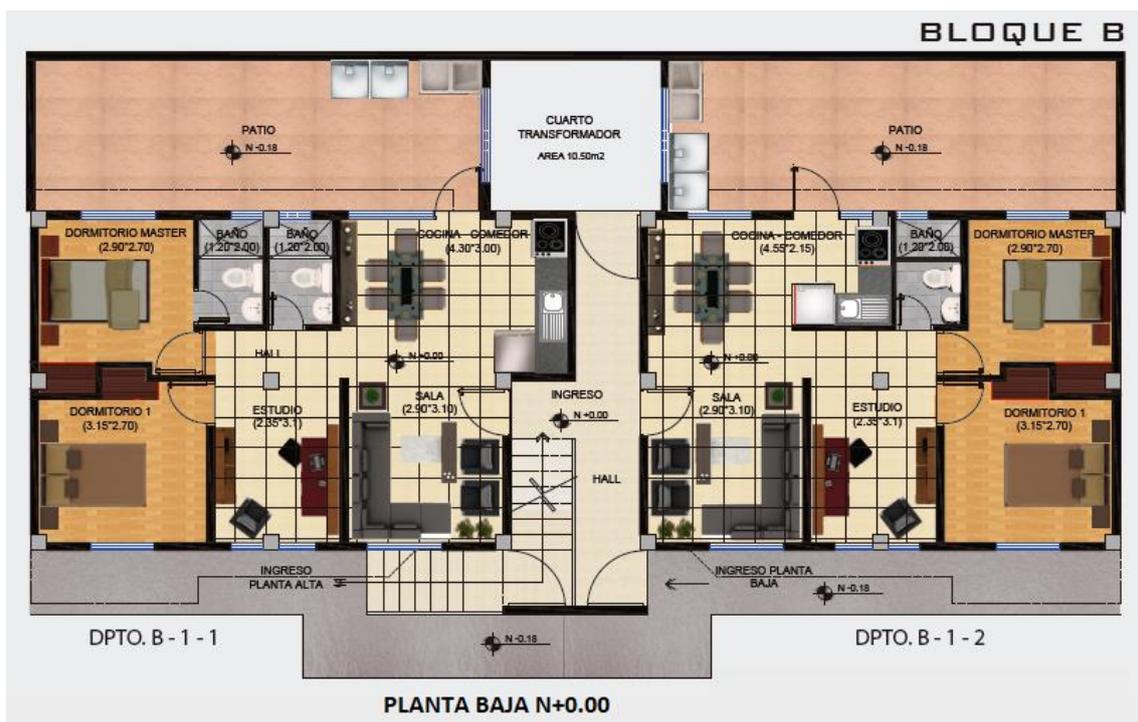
Planta Baja N+0.00 Bloque “B” Departamentos
